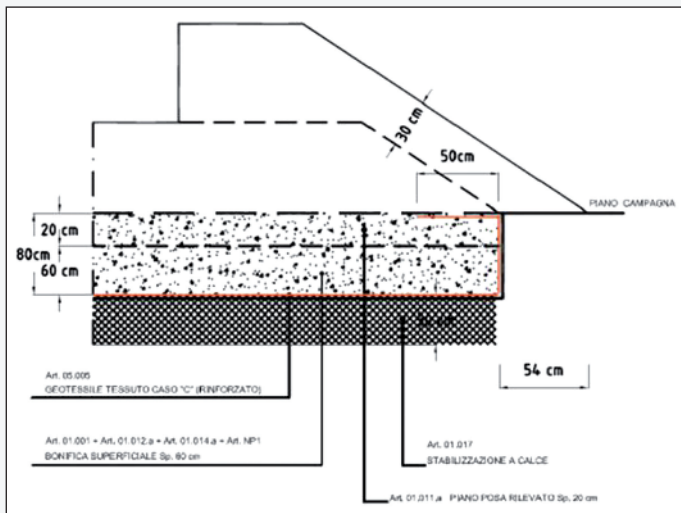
Sezione tipo per rilevati di altezza inferiore o uguale a 2,0 m
